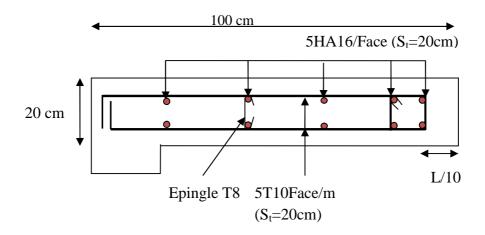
Schéma de ferraillage du voile Vx1 du niveau 1
